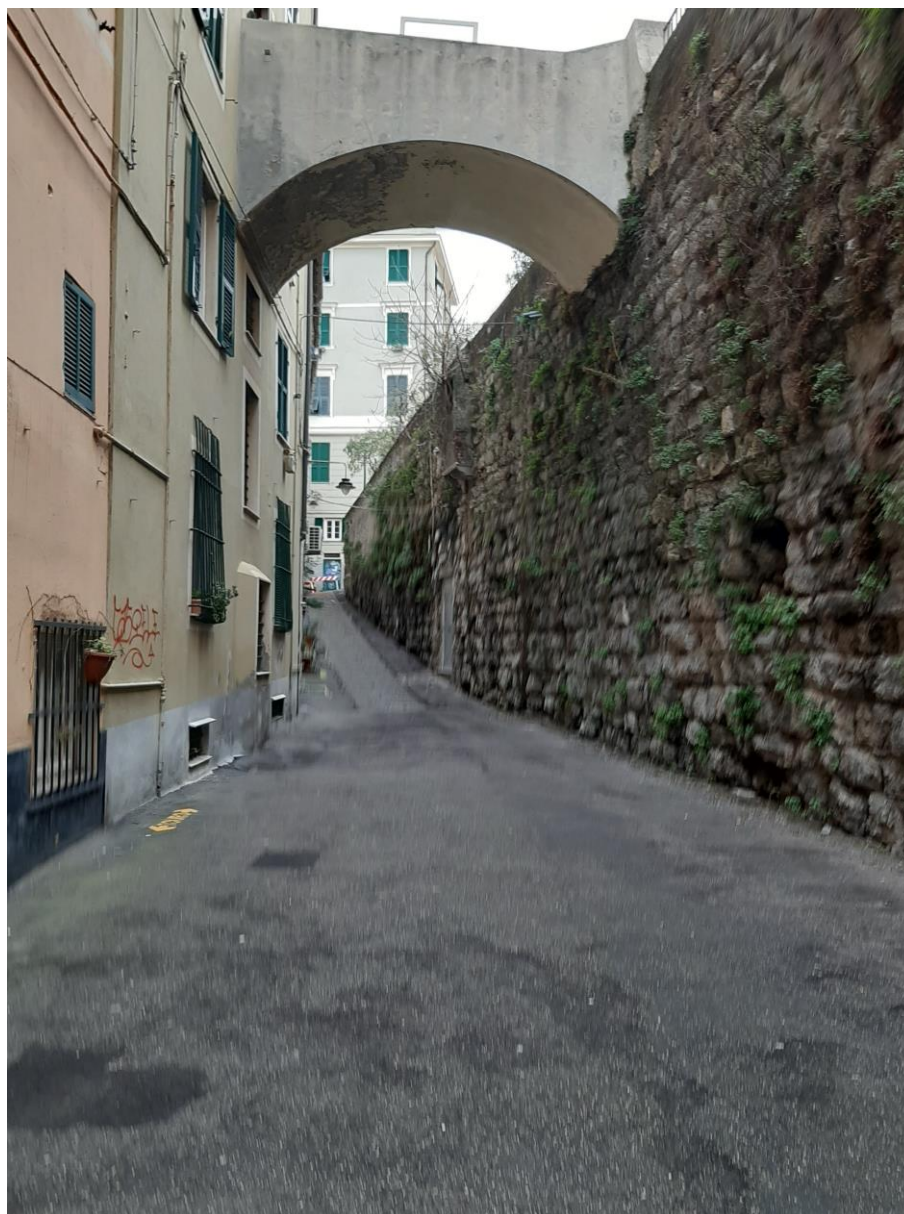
Vico sotto le Murette – zona in cui è previsto il cambio di pavimentazione
